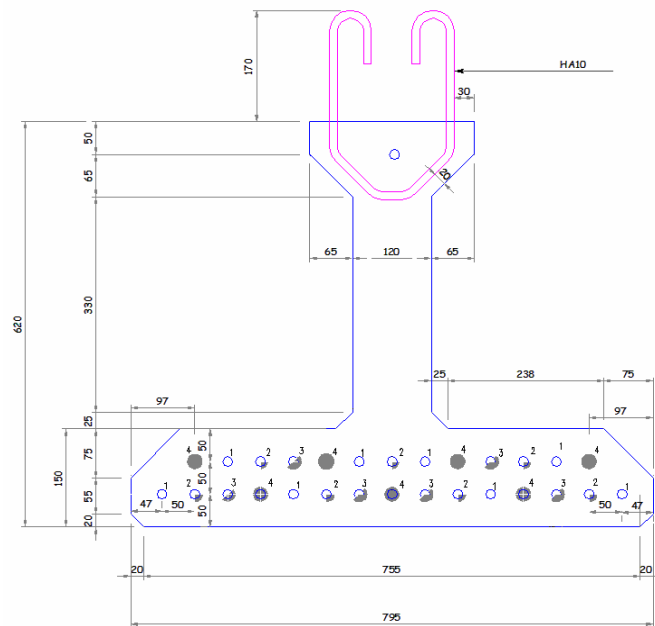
Coupe transversale d'une poutre de rive (poutre renforcée)
